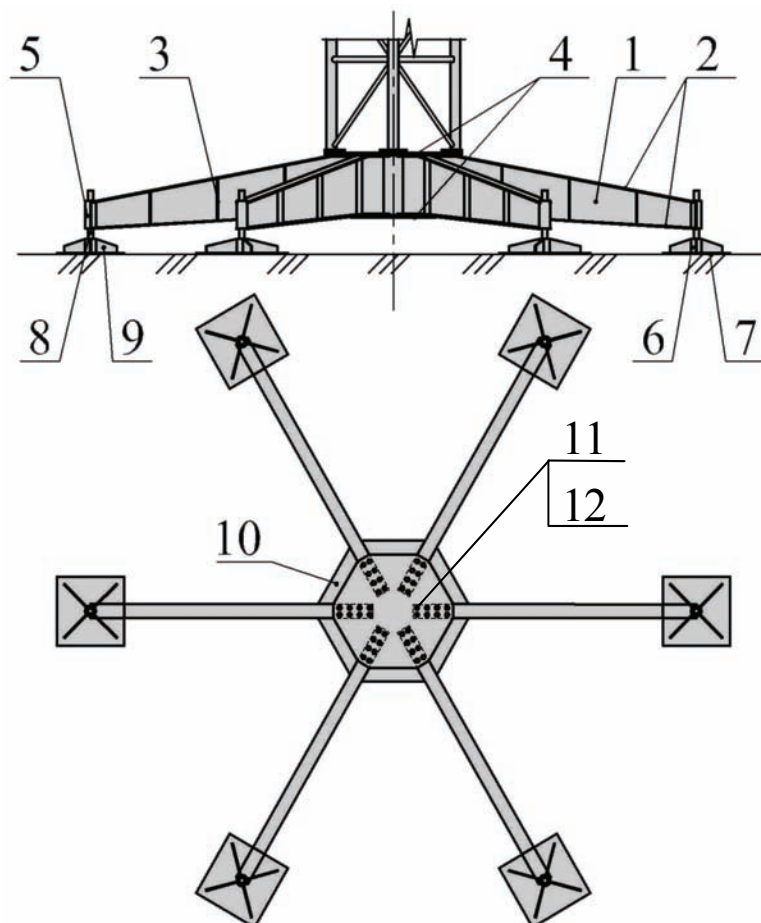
Конструктивне вирішення платформи на шести флюгерах: 1 – стінка; 2 – полиці; 3 – ребра жорсткості; 4 – діафрагма; 5 – втулка; 6 – втулка; 7 – пластина; 8 – гвинт; 9 – ребро; 10 – зв’язки; 11 – болт; 12 – гайка
